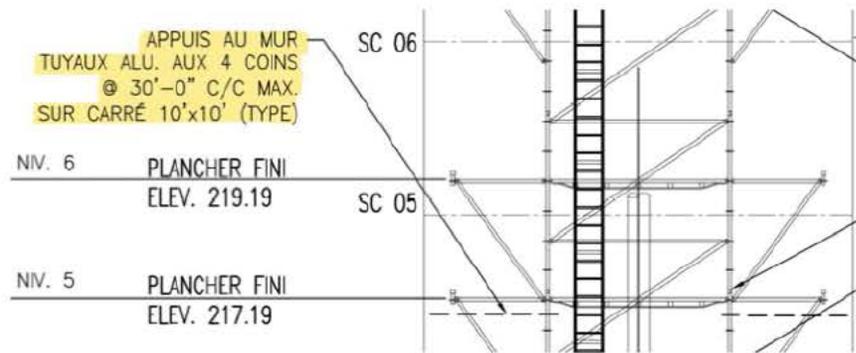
Extrait des plans, stabilisation latérale - (Baie 10' x 10')
